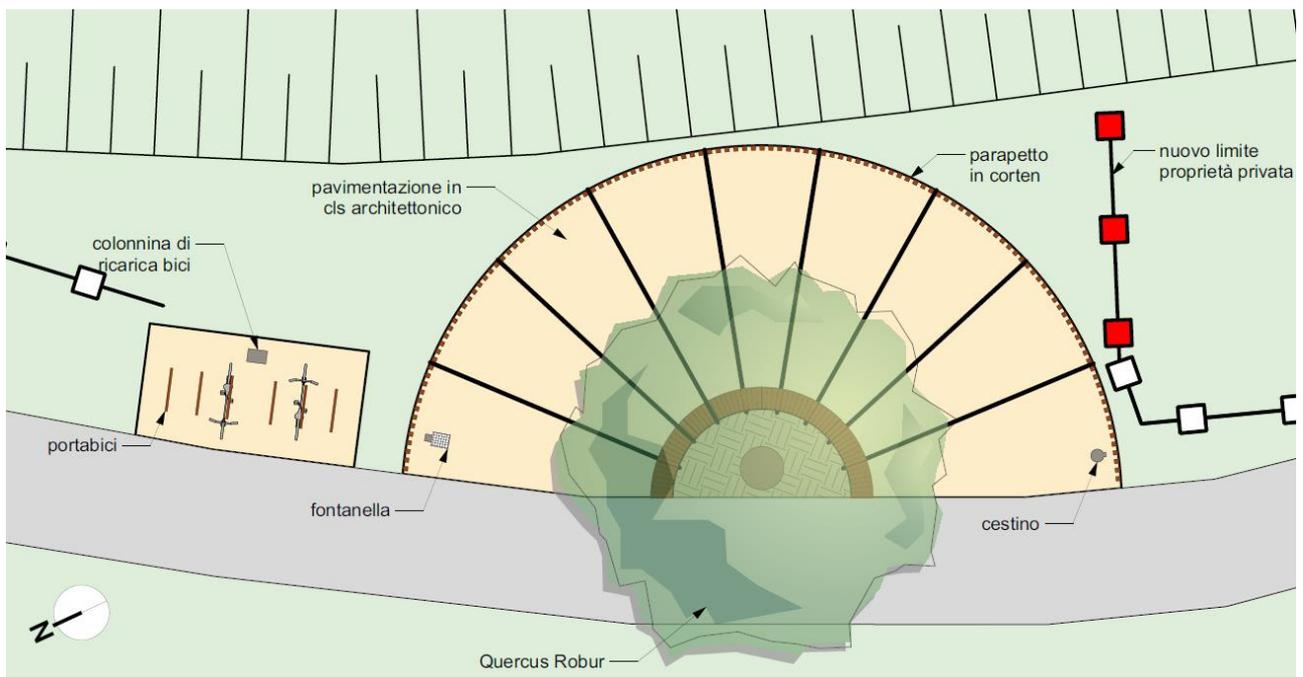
Planimetria di progetto dell'area di sosta laghetti di Porziola (elaborato INT-1-1)
